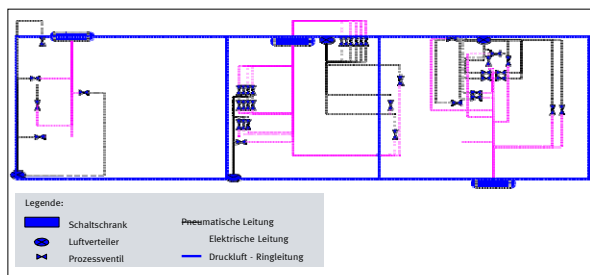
Detailbetrachtung Erdgeschoss – Einzelventile.
